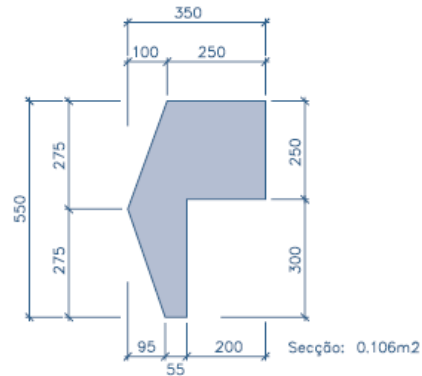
Vigas de bordadura, dimensões em mm. [Pavicentro]
